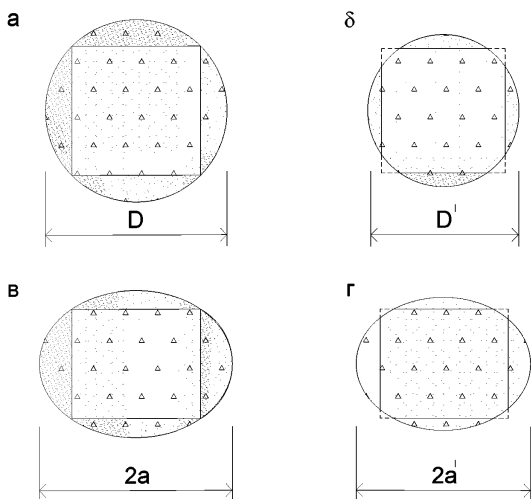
Усиление квадратных (а, б) и прямоугольных (в, г) колонн с изменением их формы поперечного сечения соответственно на круглую и эллипсовидную
